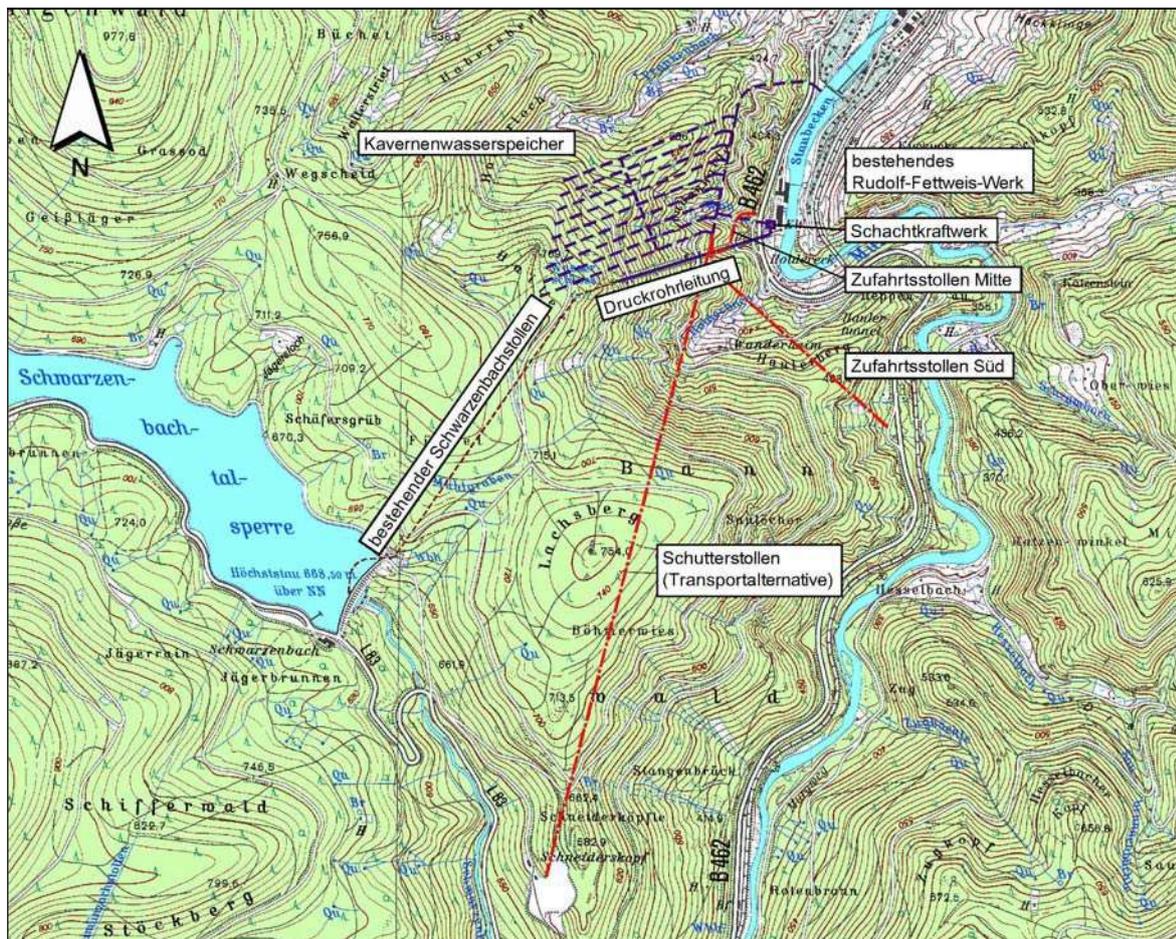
Lageplan Alternative 12 - Unterstufe Kaverne (klein)
